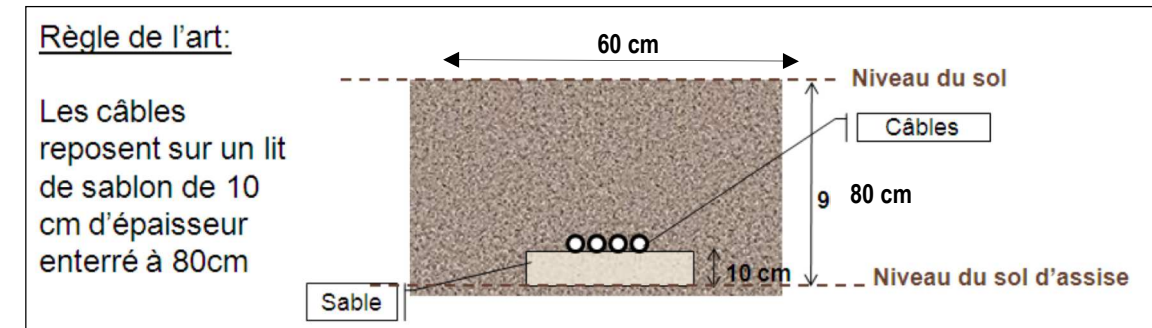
Coupe type de tranchée au sein du projet (Source internet)
